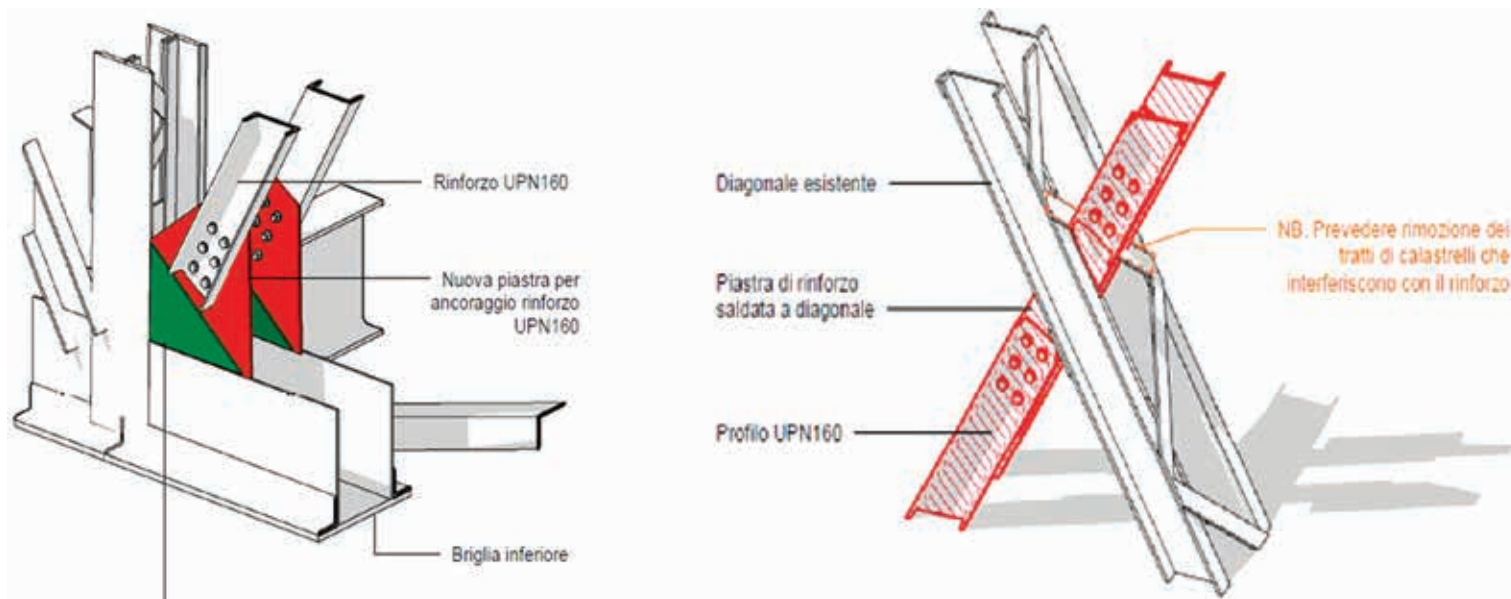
| Dettagli degli interventi strutturali negli elementi in acciaio
